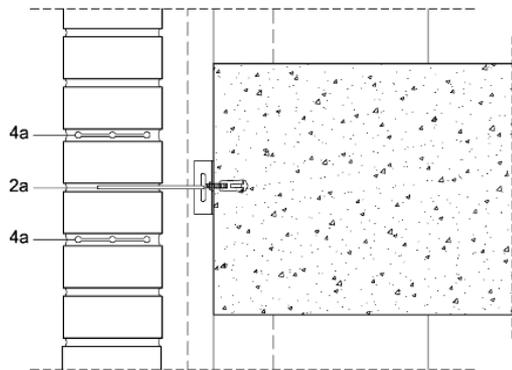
Sección vertical. Detalle de fijación de anclaje GEOANC® a forjado o pilar.
